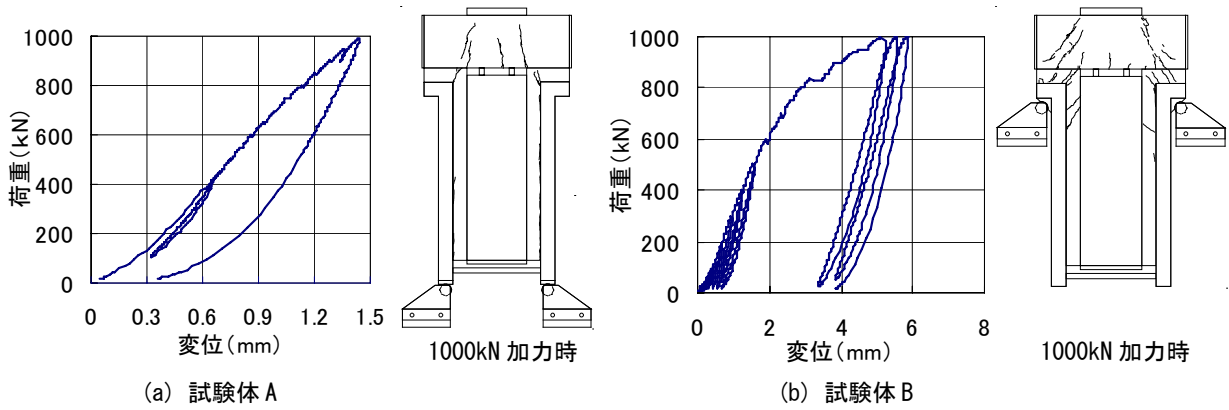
荷重-変位関係と最終ひび割れ状況 (実験1)
